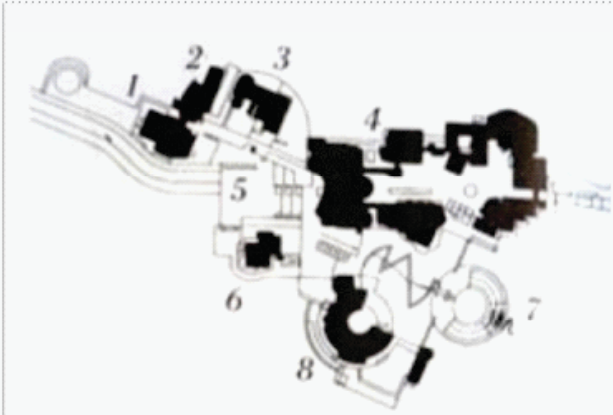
Planta baja de la Plaza de entrada, cortesía de Richard Meyer & Partes.
